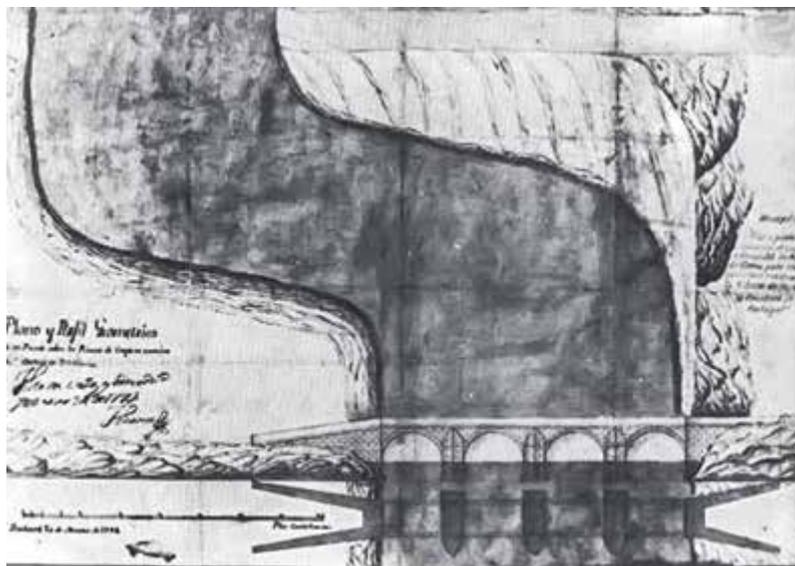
Plano perfil y condiciones con las adicionales de D. Marcos de Vierna para el puente que se hace construir en la ribera de Caya en 20 de enero de 1778, CGE, ACEG, Extremadura 157.
